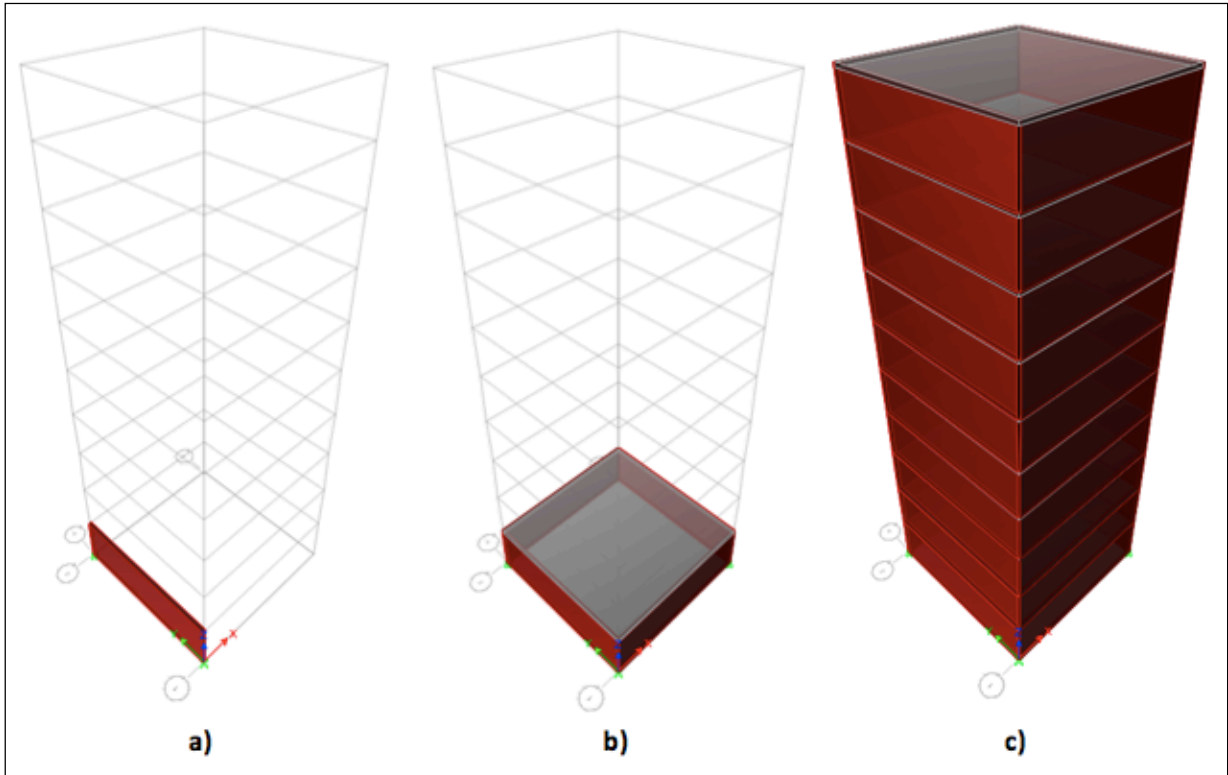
Secuencia de modelado de muros con elementos de tipo área
